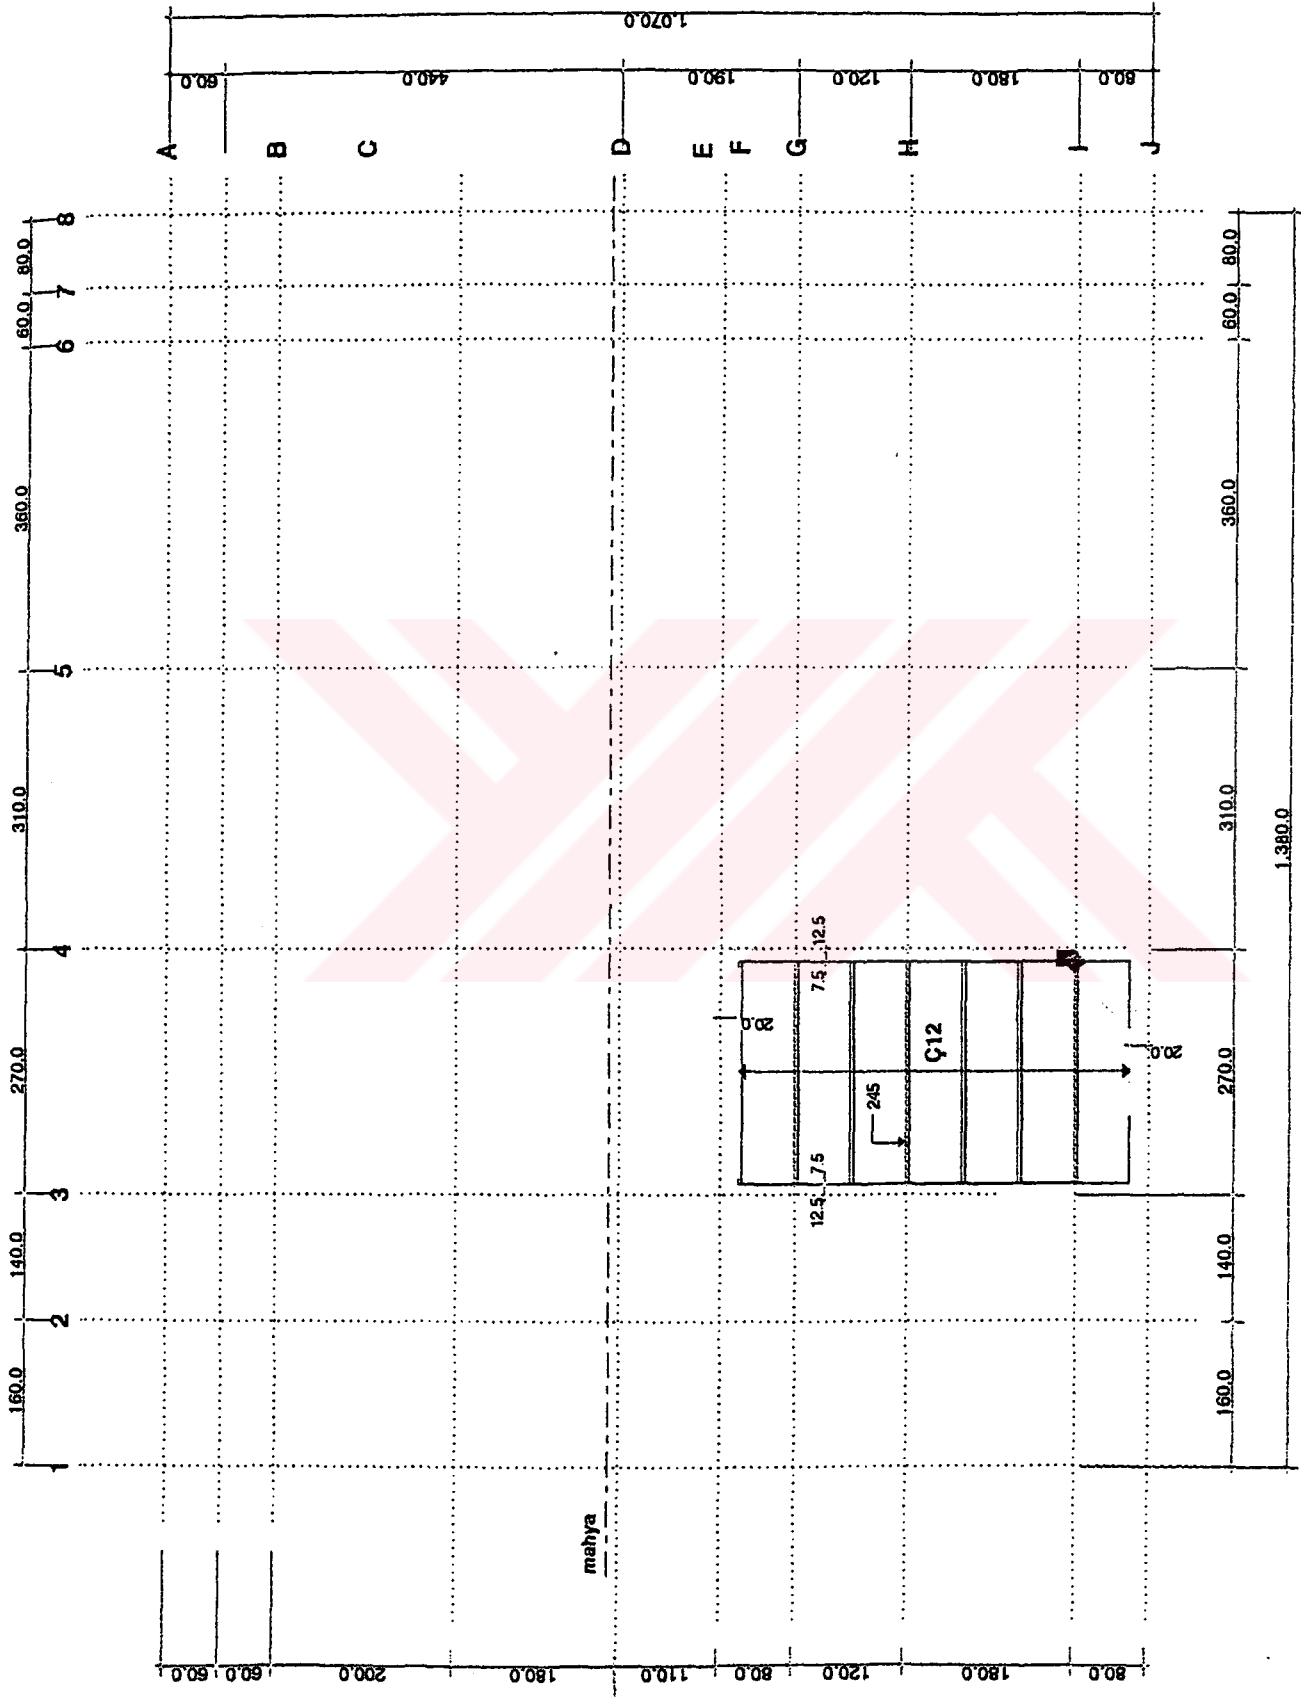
Zemin Kat Tavanı Döşeme Montaj Planı
